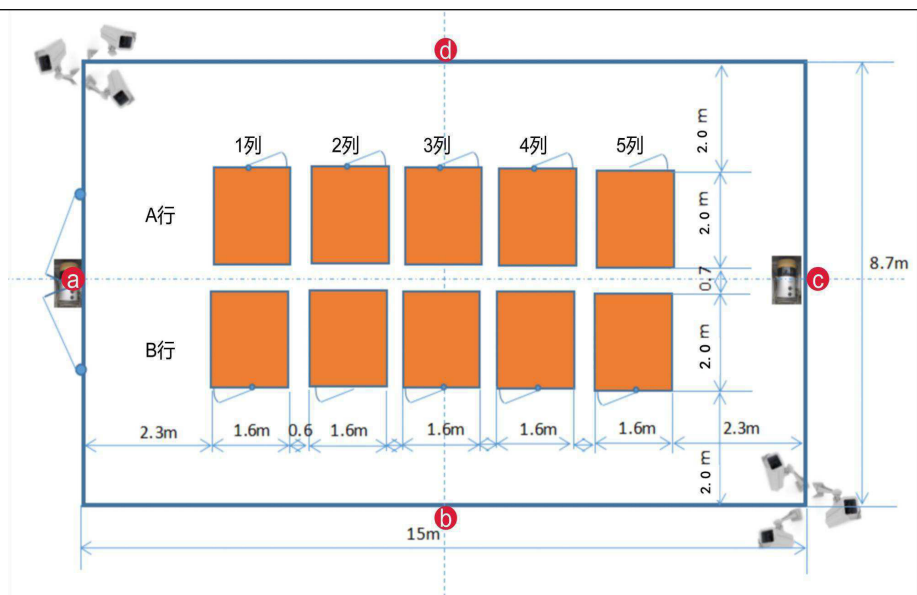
(a) 放射源临时储存库预测点平面布置示意图
